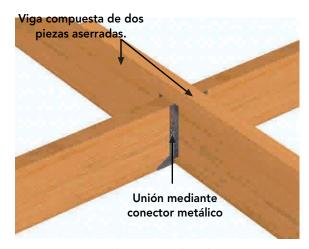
58: Unión de viga secundaria de tope a viga principal compuesta mediante conector metálico, según cálculo.
